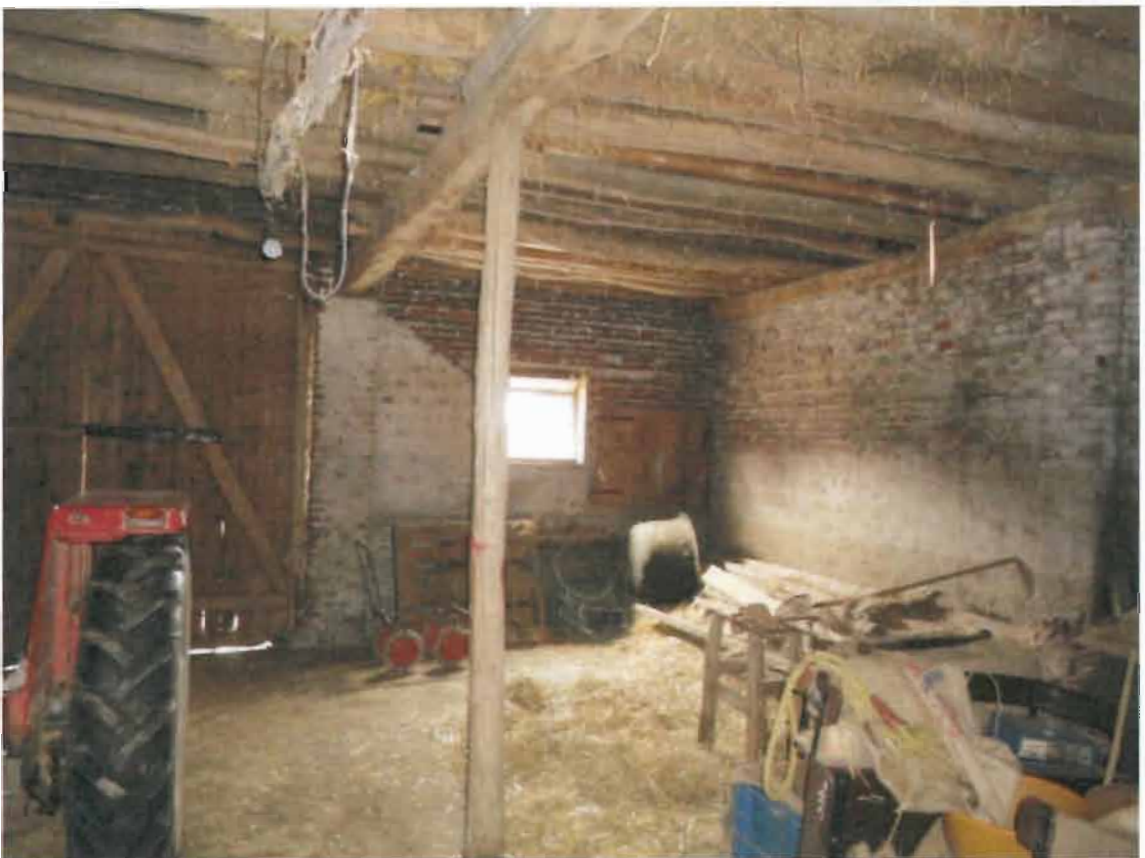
opslag hooi en stalling tractor in voormalige stal (19 september 2011)
